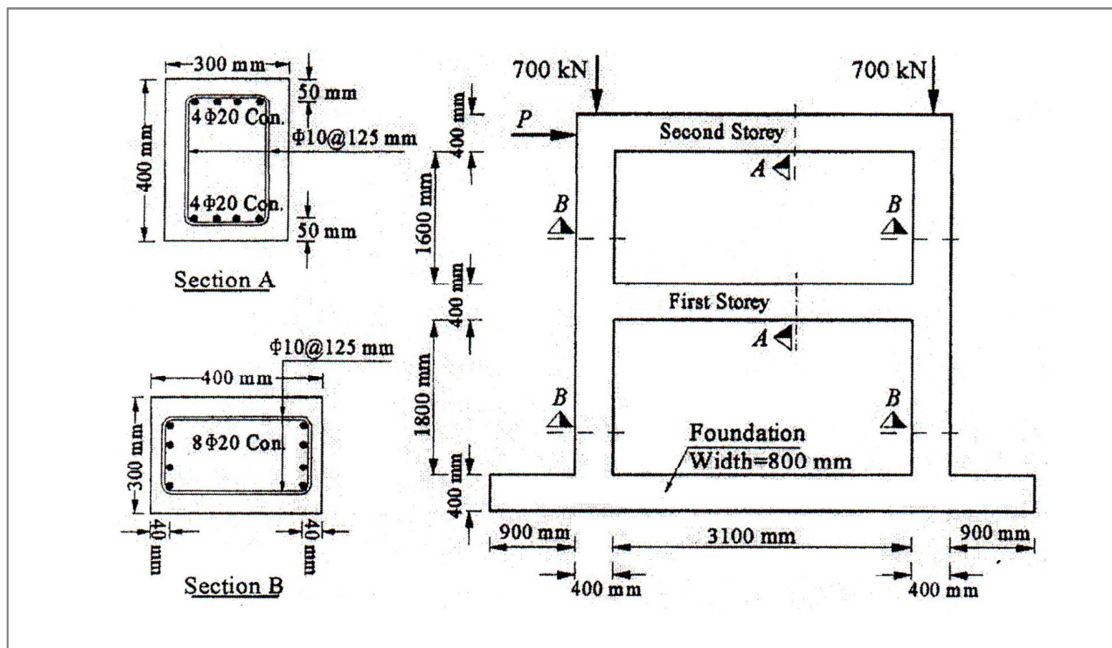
Caractéristiques géométriques et ferrailages du portique du Vecchio et Emara.
